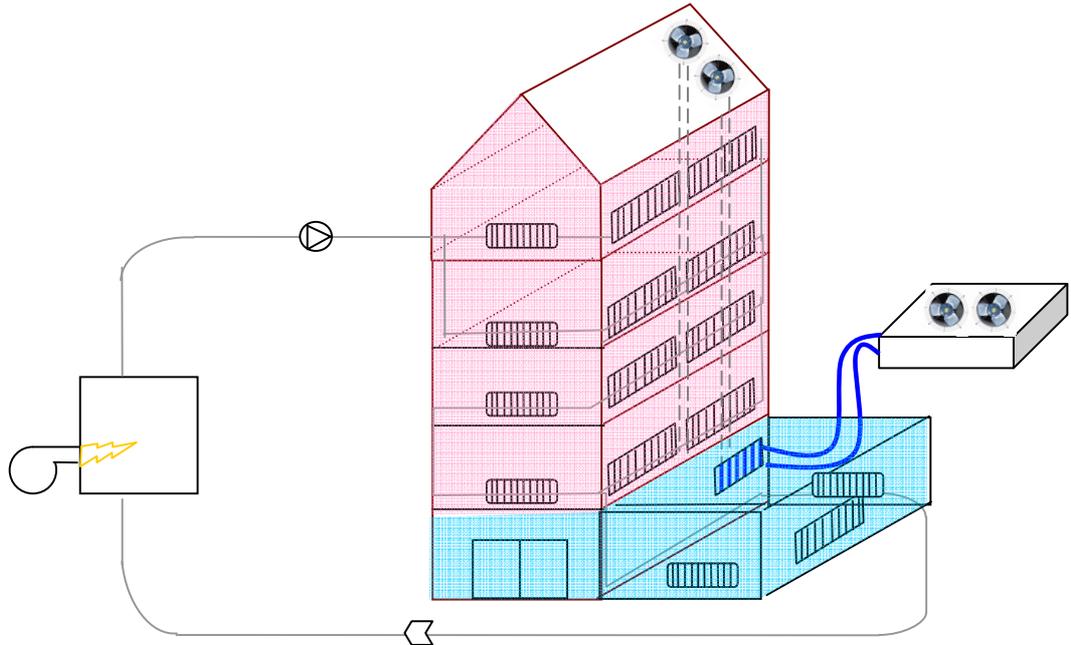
bâtiment de bureaux. Au rez-de-chaussée, la présence d'un atrium vitré a imposé l'installation d'un système de refroidissement pour tout l'étage
